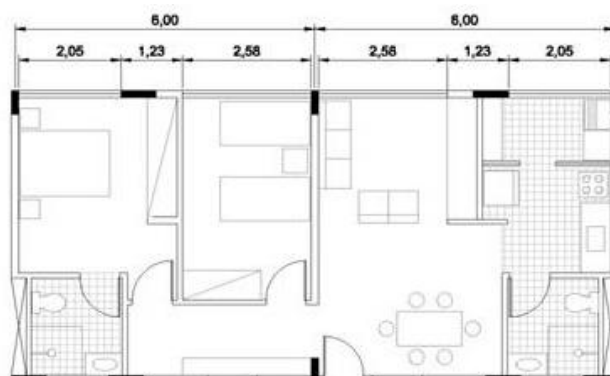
Planta de arquitetura e estrutura do Módulo Tipo.
